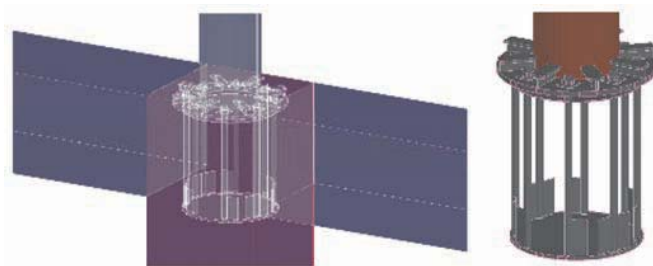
Prinderea la bază a stâlpilor în structura de beton
